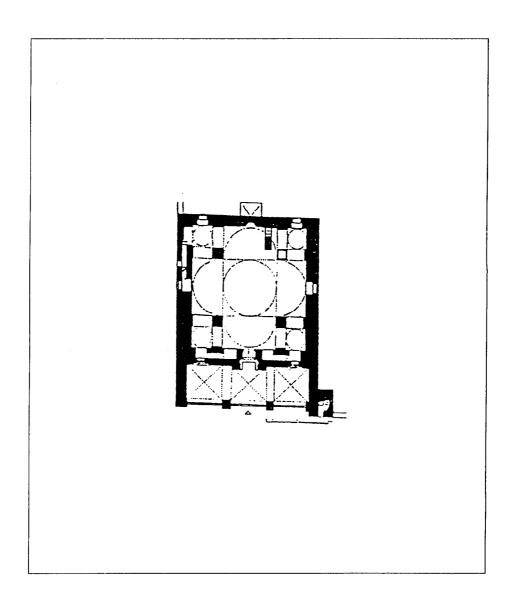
مسقط أفقي لمسجد فرهاد باشا في بانيا لوكا (عن : ايفردى).
